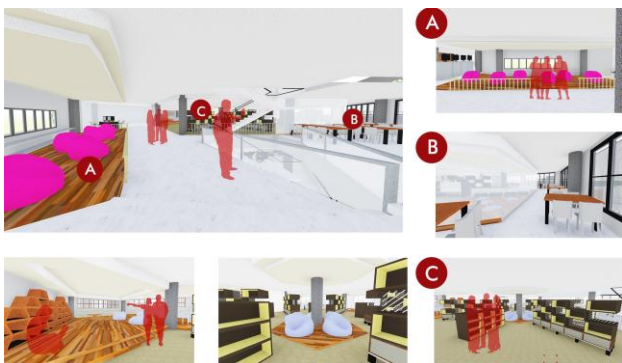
Potongan dan perspektif detail ruang 2.
